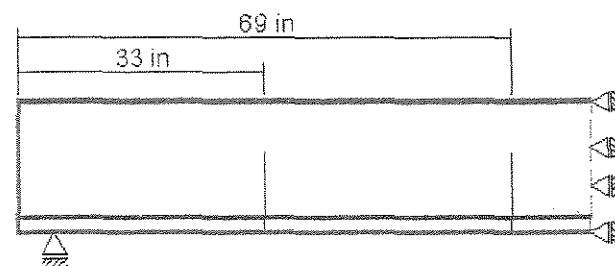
Viga com duas fissuras.
